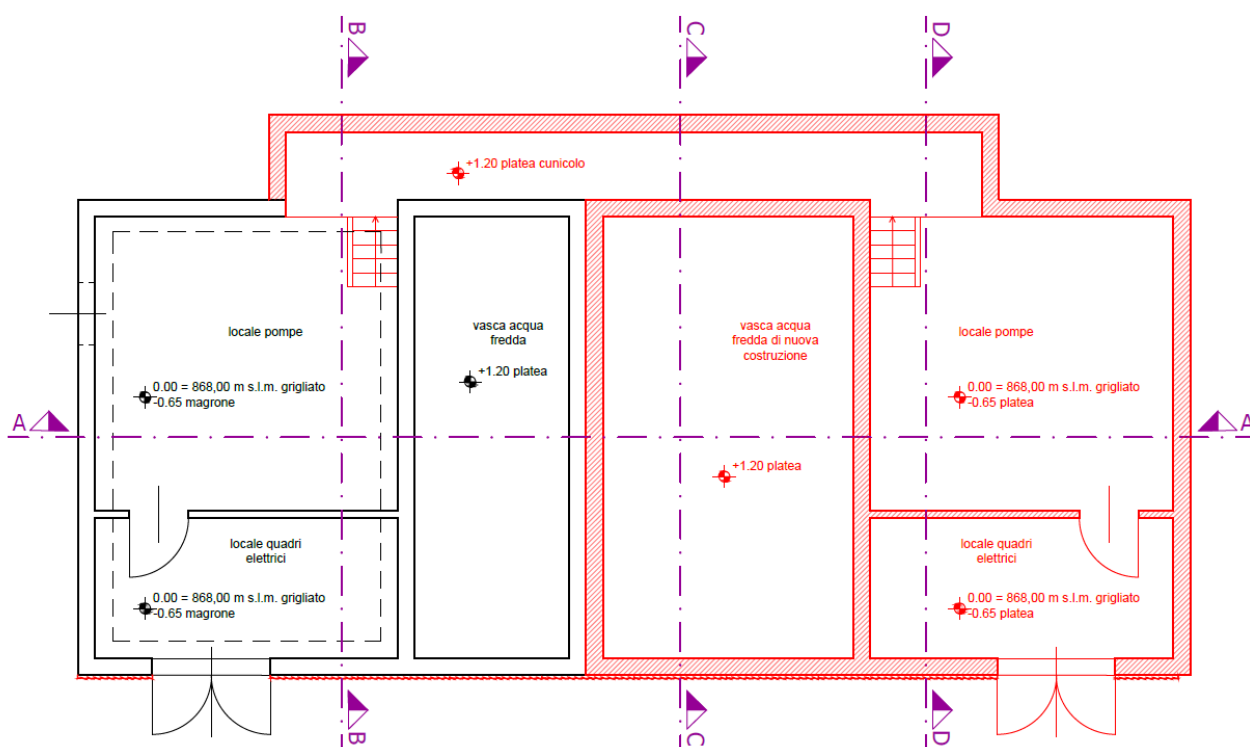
Estratto pianta raffronto locale pompe - sala a vista
